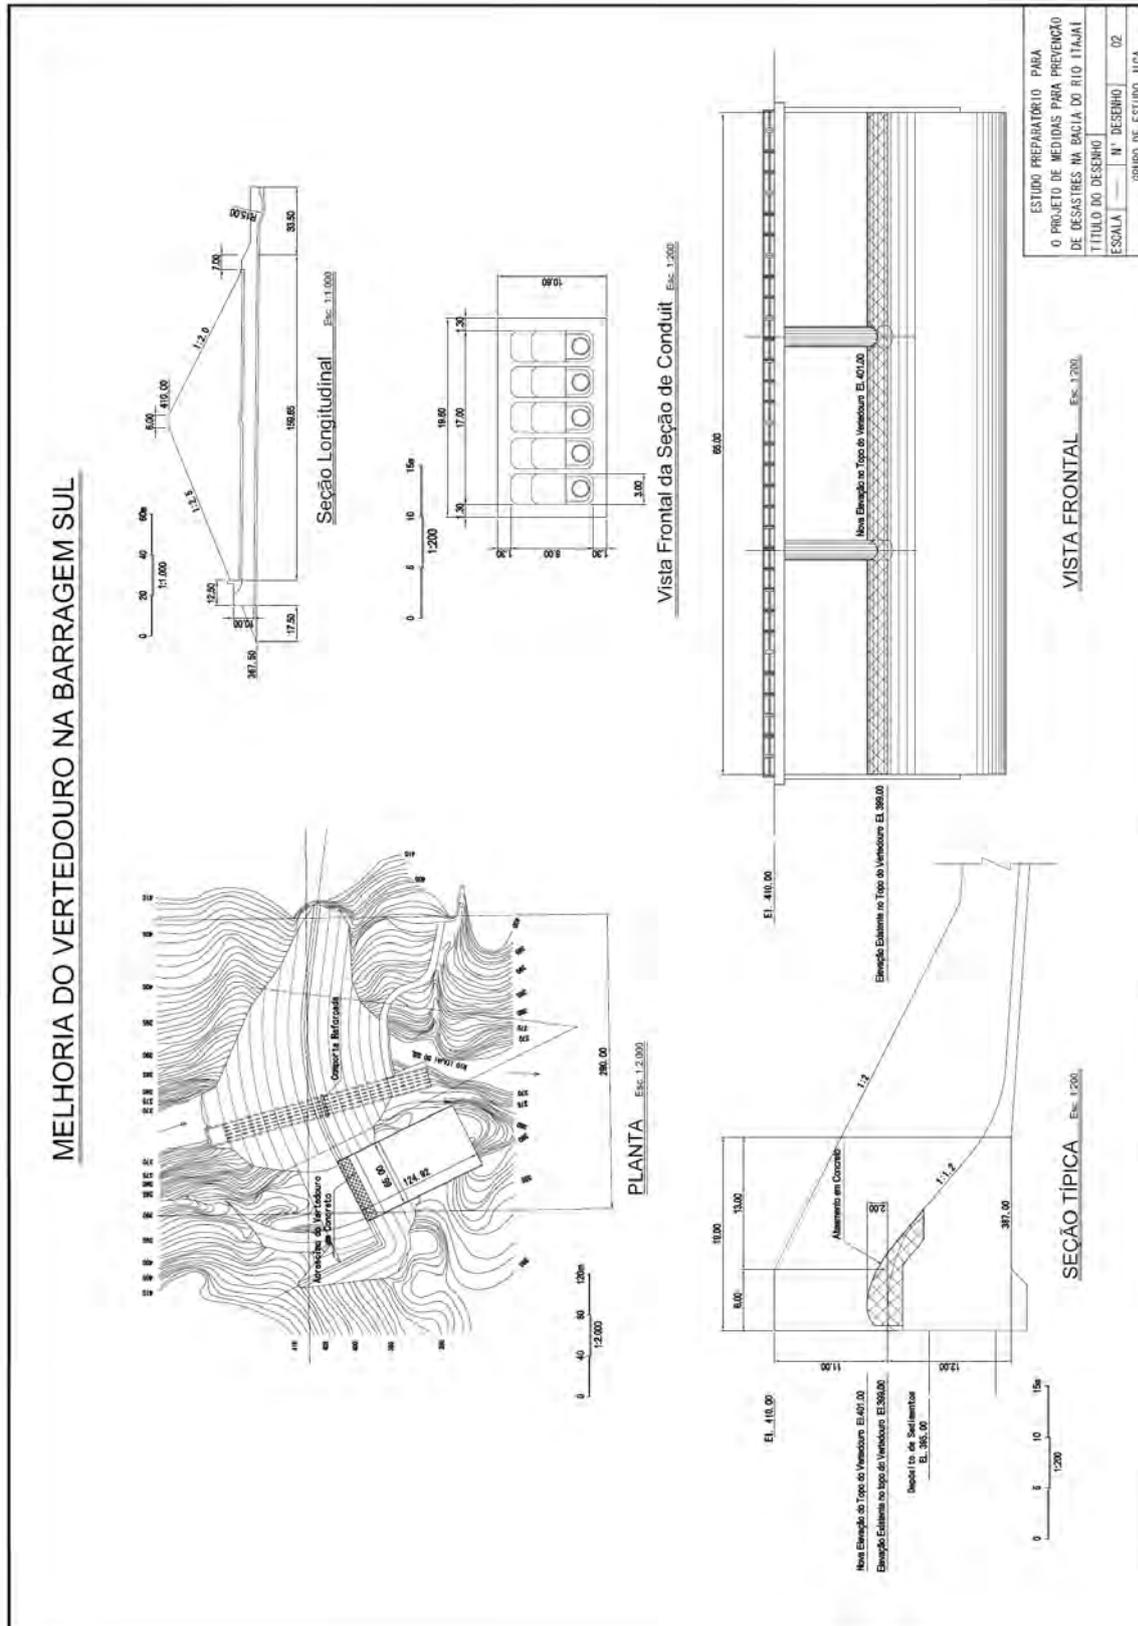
Desenho estrutural da sobre-elevação do vertedouro da barragem Sul
